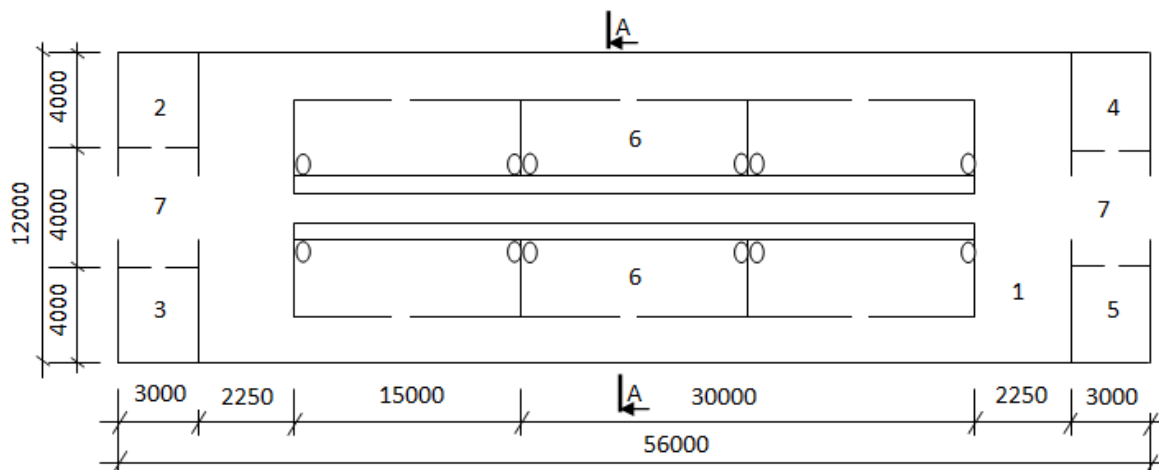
План і схема цеху з вирощування ягнят на 2000 голів і дорощування ремонтних ярок на 900 голів
